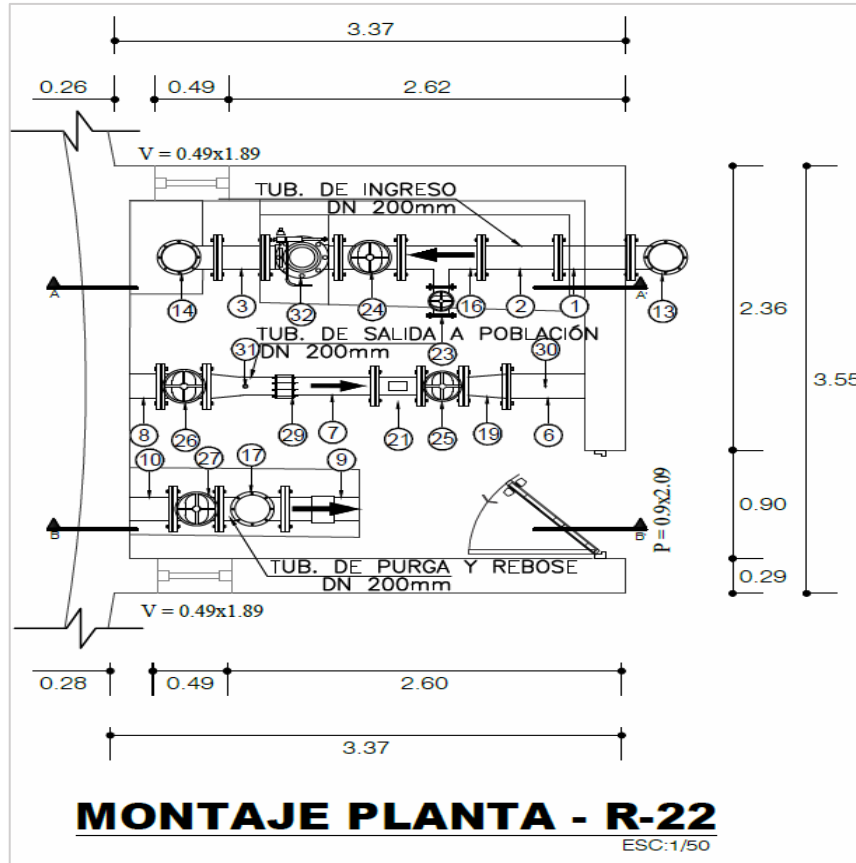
Plano cámara válvulas Reservorio R-22 (Accesorios)
